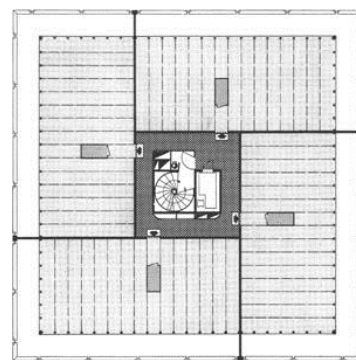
PLANTA FLEXÍVEL, MONTEREAU , LES FRÈRES ARSÈNE-HENRY, 1971
